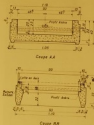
(à droite). — Vue en coupe transversale d'un élément façade posé sur la poutre.
